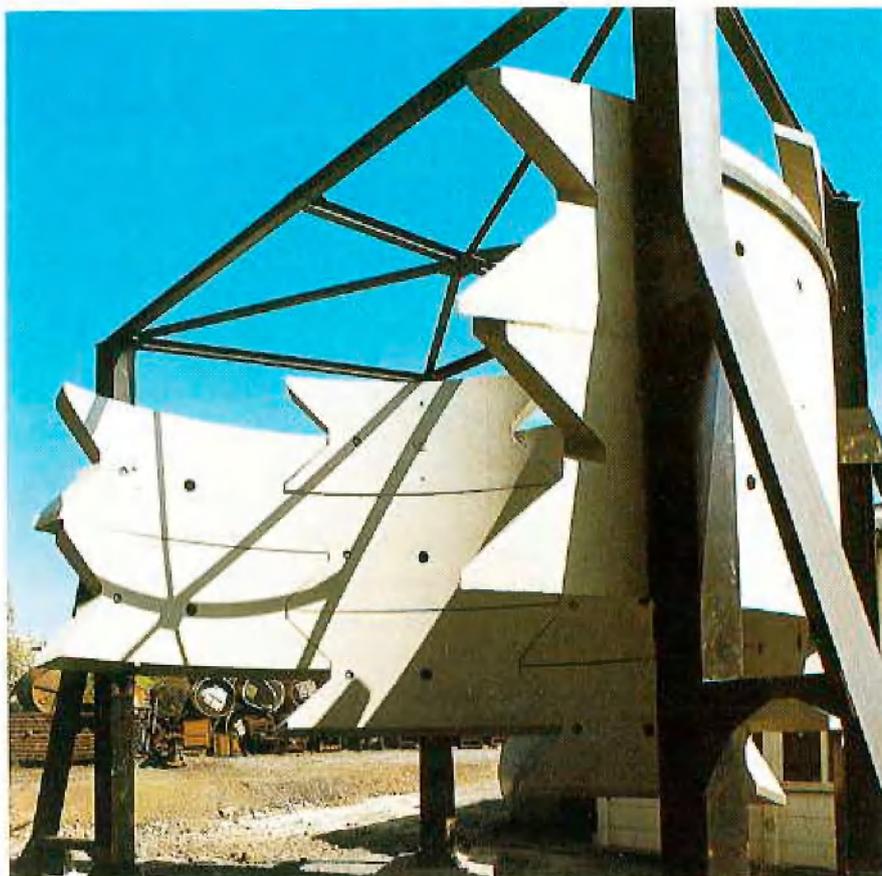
Versuchsschachtmodell im Maßstab 1:1 mit eingebauten Stahlbetonfertigteilen
